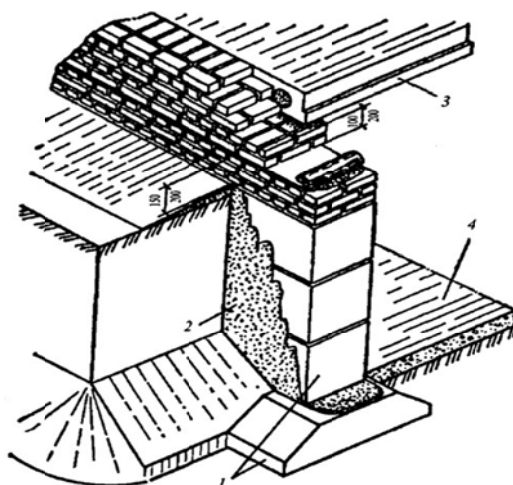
Окрасочная гидроизоляция в здании с подвалом:
